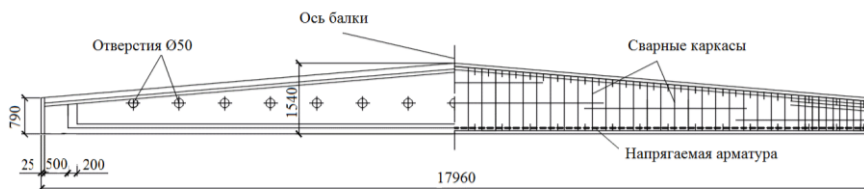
Двускатная балка покрытия двугаврового сечения пролетом 18 м
